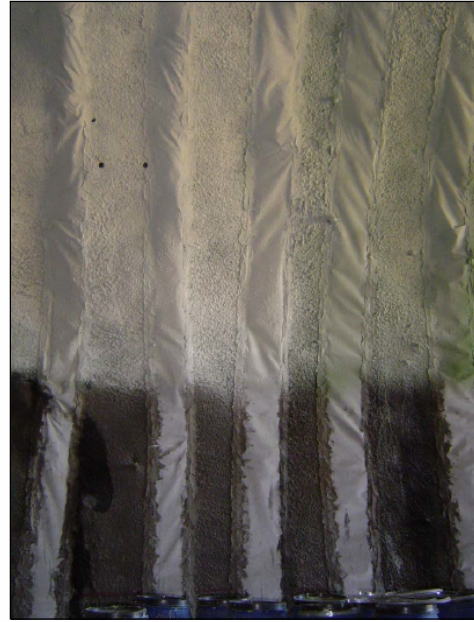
Tiras de geotextil cubiertas con la membrana impermeable en túnel La Pólvora, Chile. [87] Asocreto.
